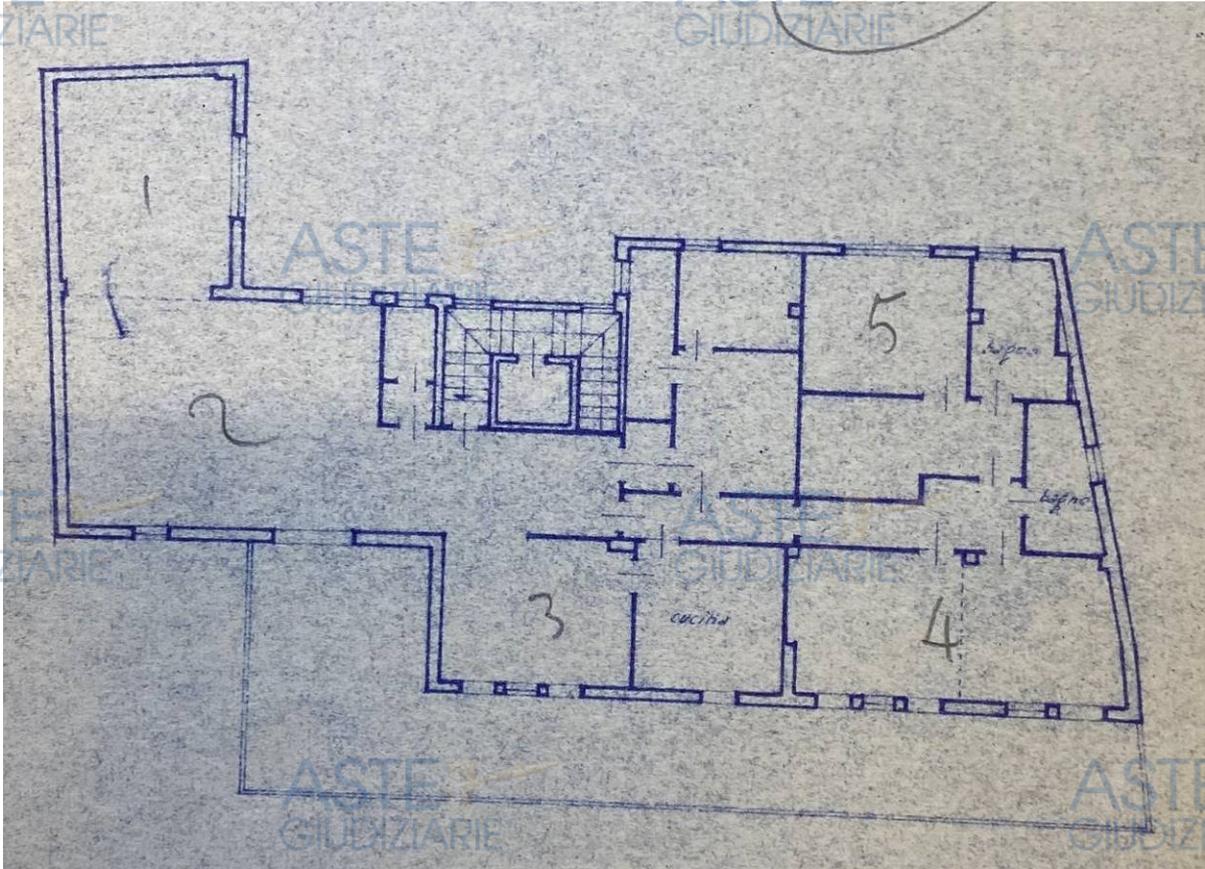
Estratto pianta di progetto di variante Prot. Gen. 13711/1967 Prot. U.T. 2161 del 17.05.1967 -Piano attico
